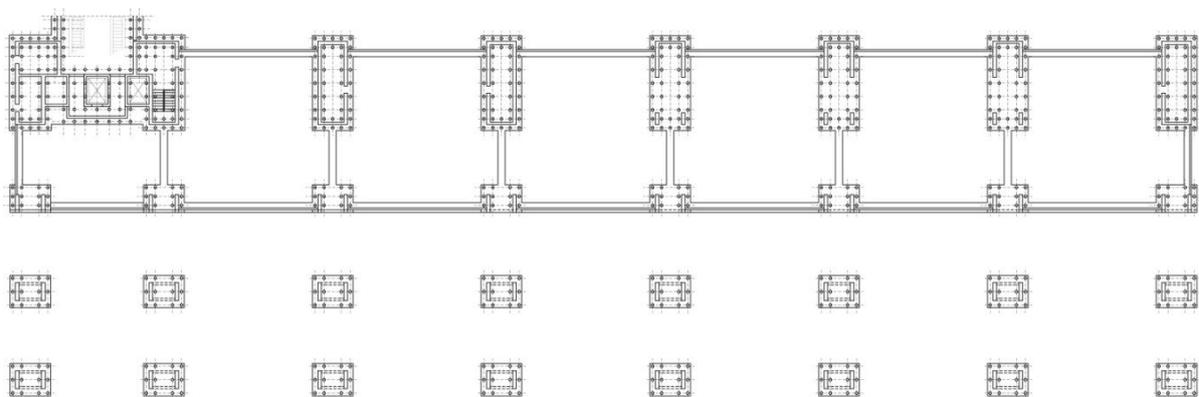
La pianta delle fondazioni mostra la permeabilità delle strutture al movimento dell'acqua
